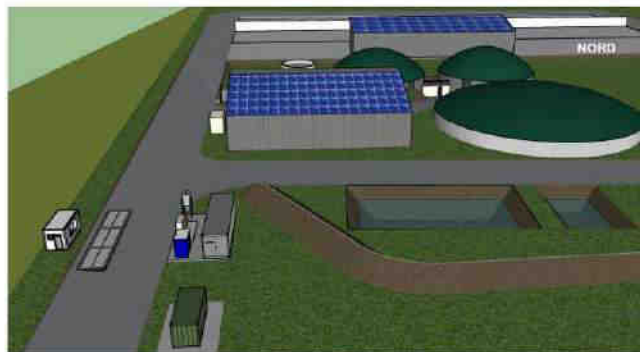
Plan masse retenu du projet d'unité de méthanisation (avril 2020)
